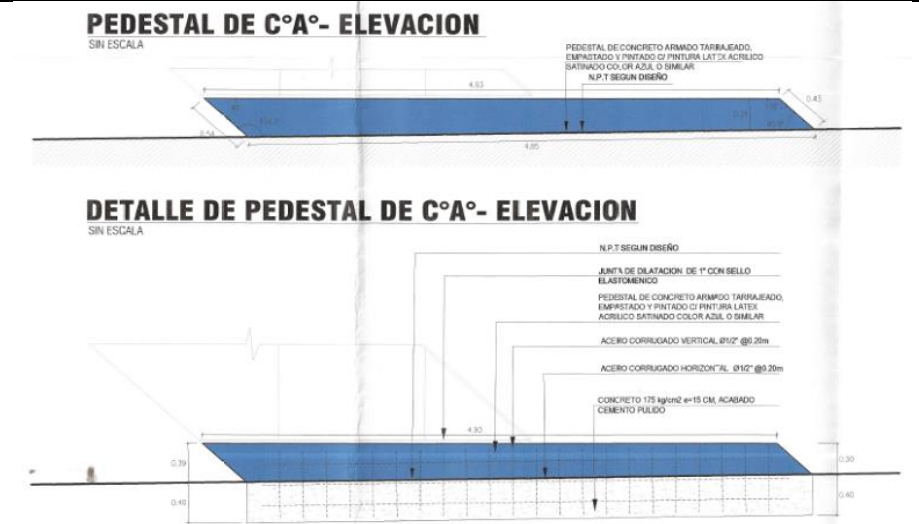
Detalles del pedestal de apoyo de la fachada ventilada del ingreso principal del recinto deportivo, establecidos en el plano DFV-01 Detalle de fachada ventilada.
